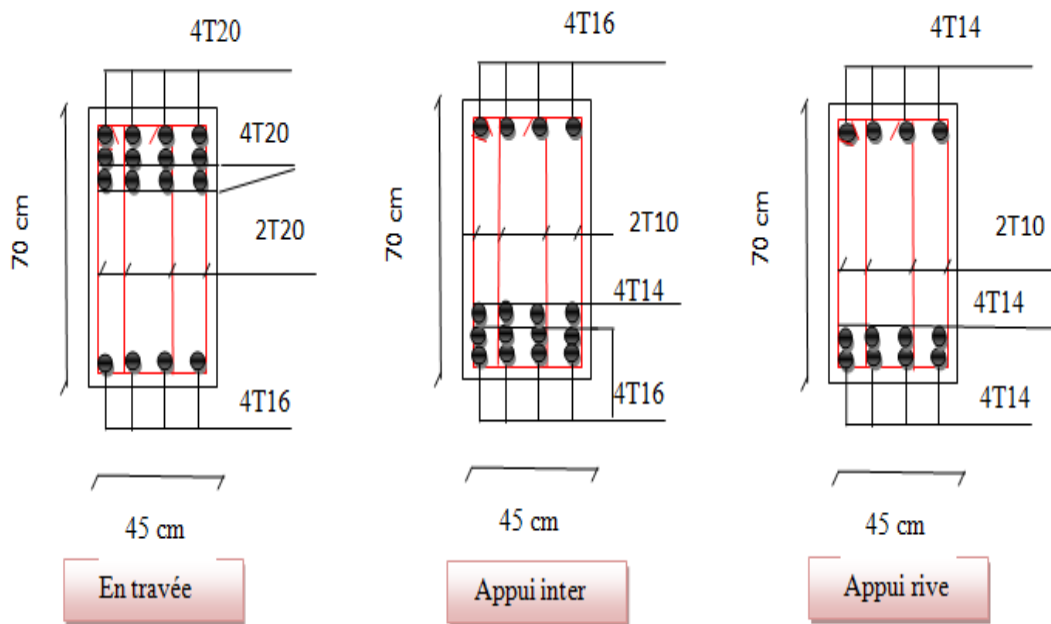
Ferrailage de la poutre de libage suivant le sens longitudinale.
